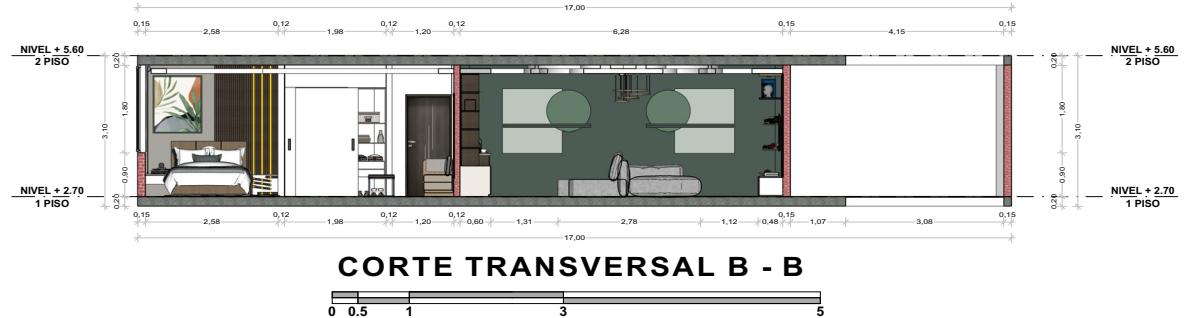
Autoría Jose Cruz. Corte Transversal ambientado.
